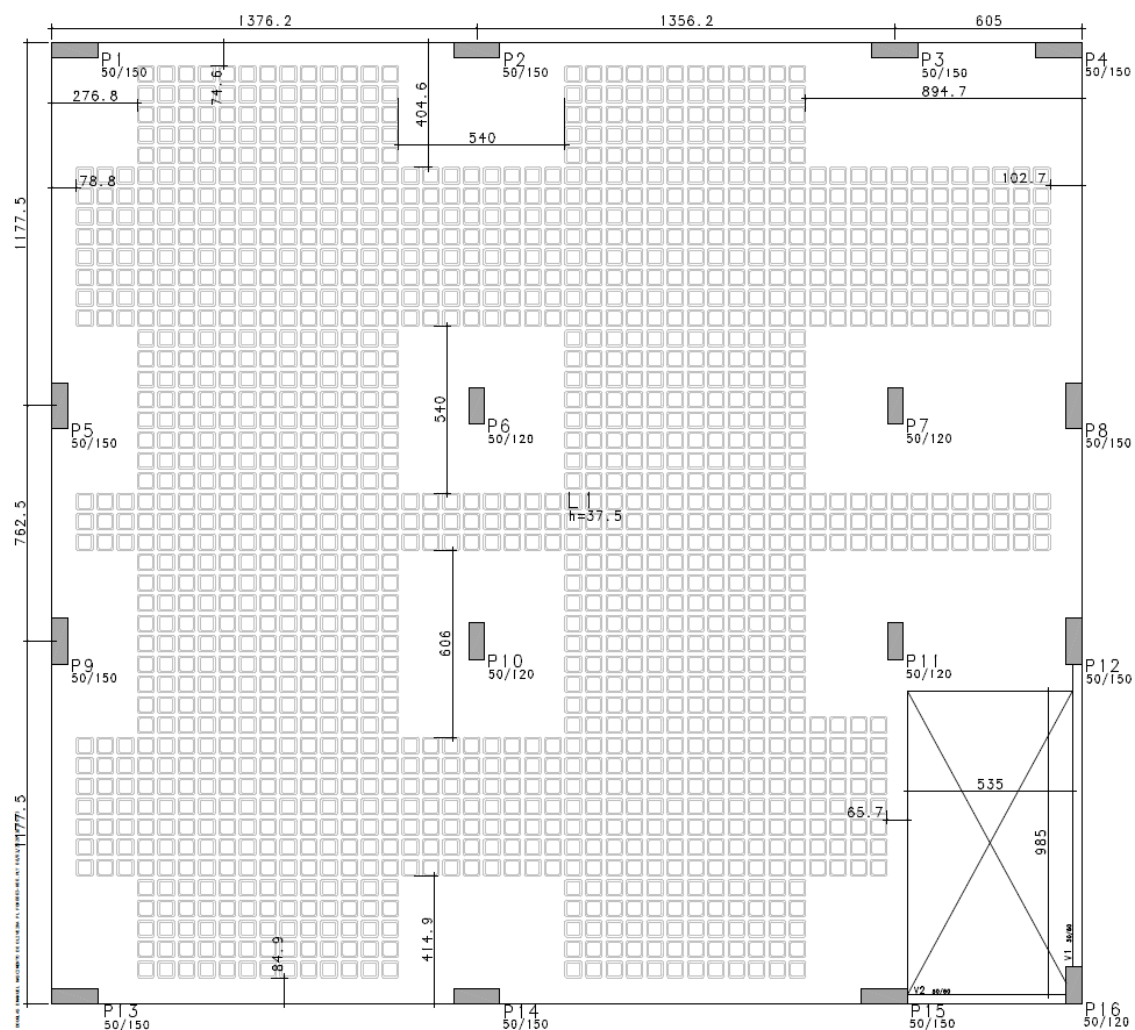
Projeto C2 - Planta de forma (dimensões em cm).
